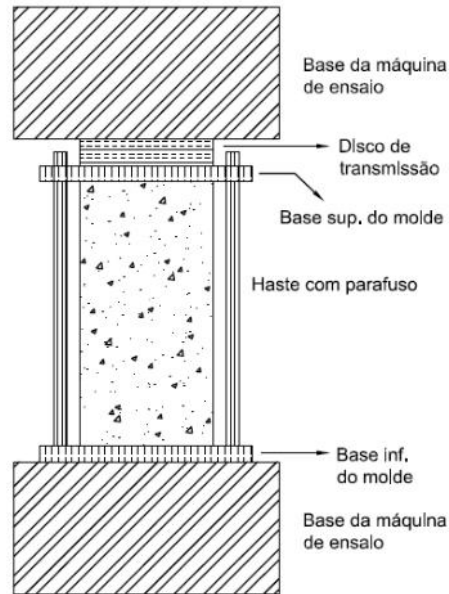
Desenho esquemático do dispositivo de aplicação de carga
